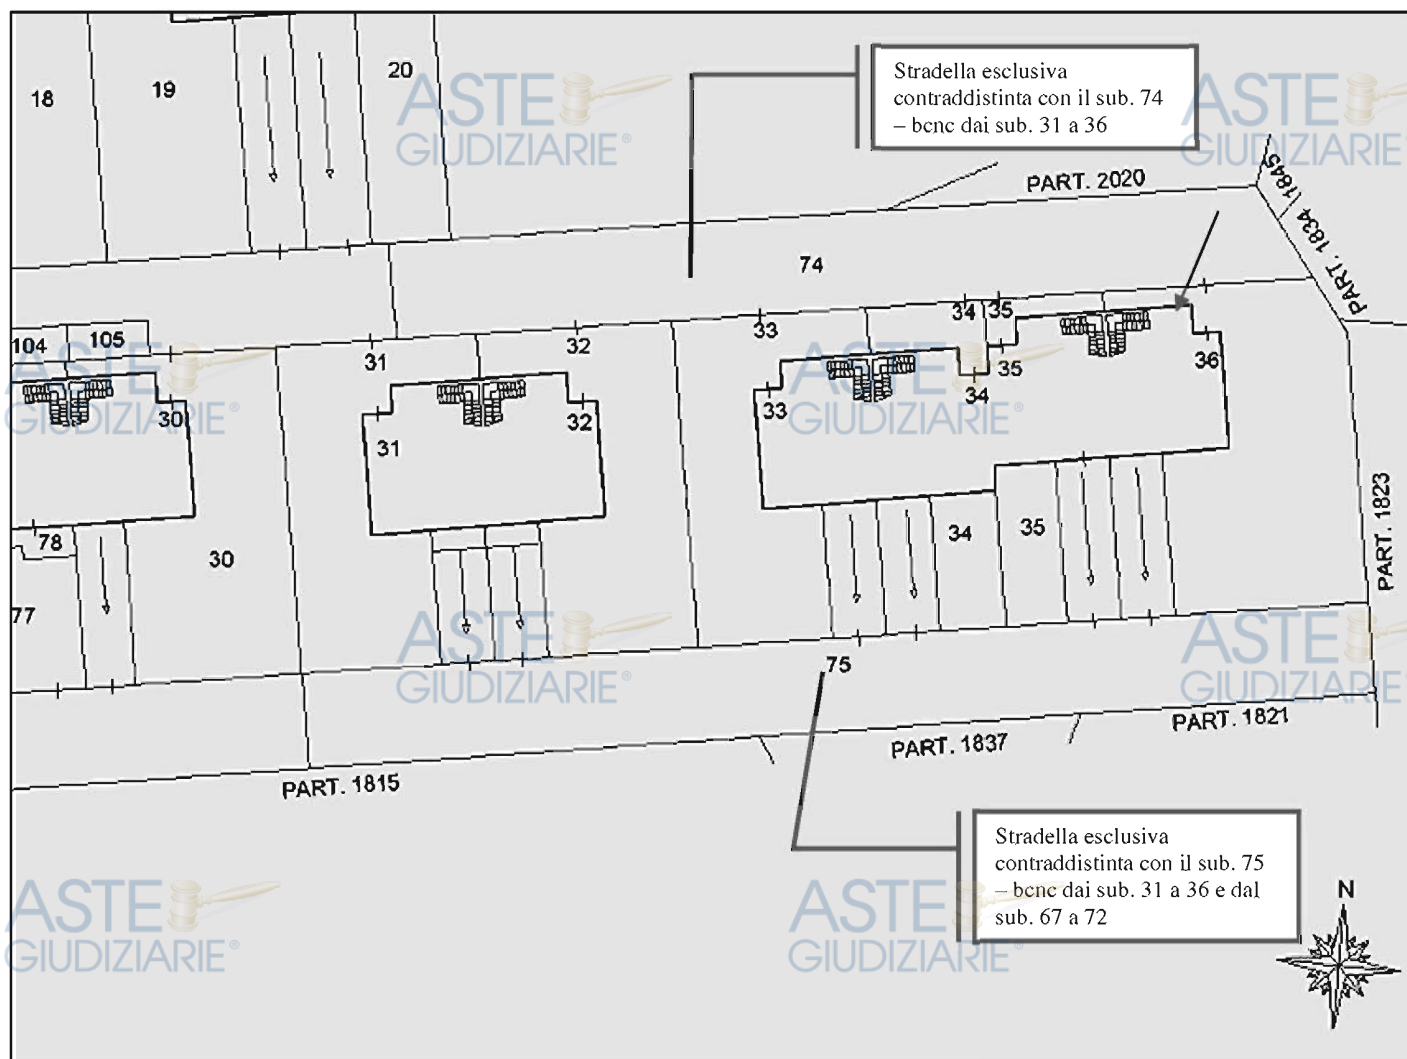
Visualizzazione dei beni oggetto della presente sezione- piano terra
